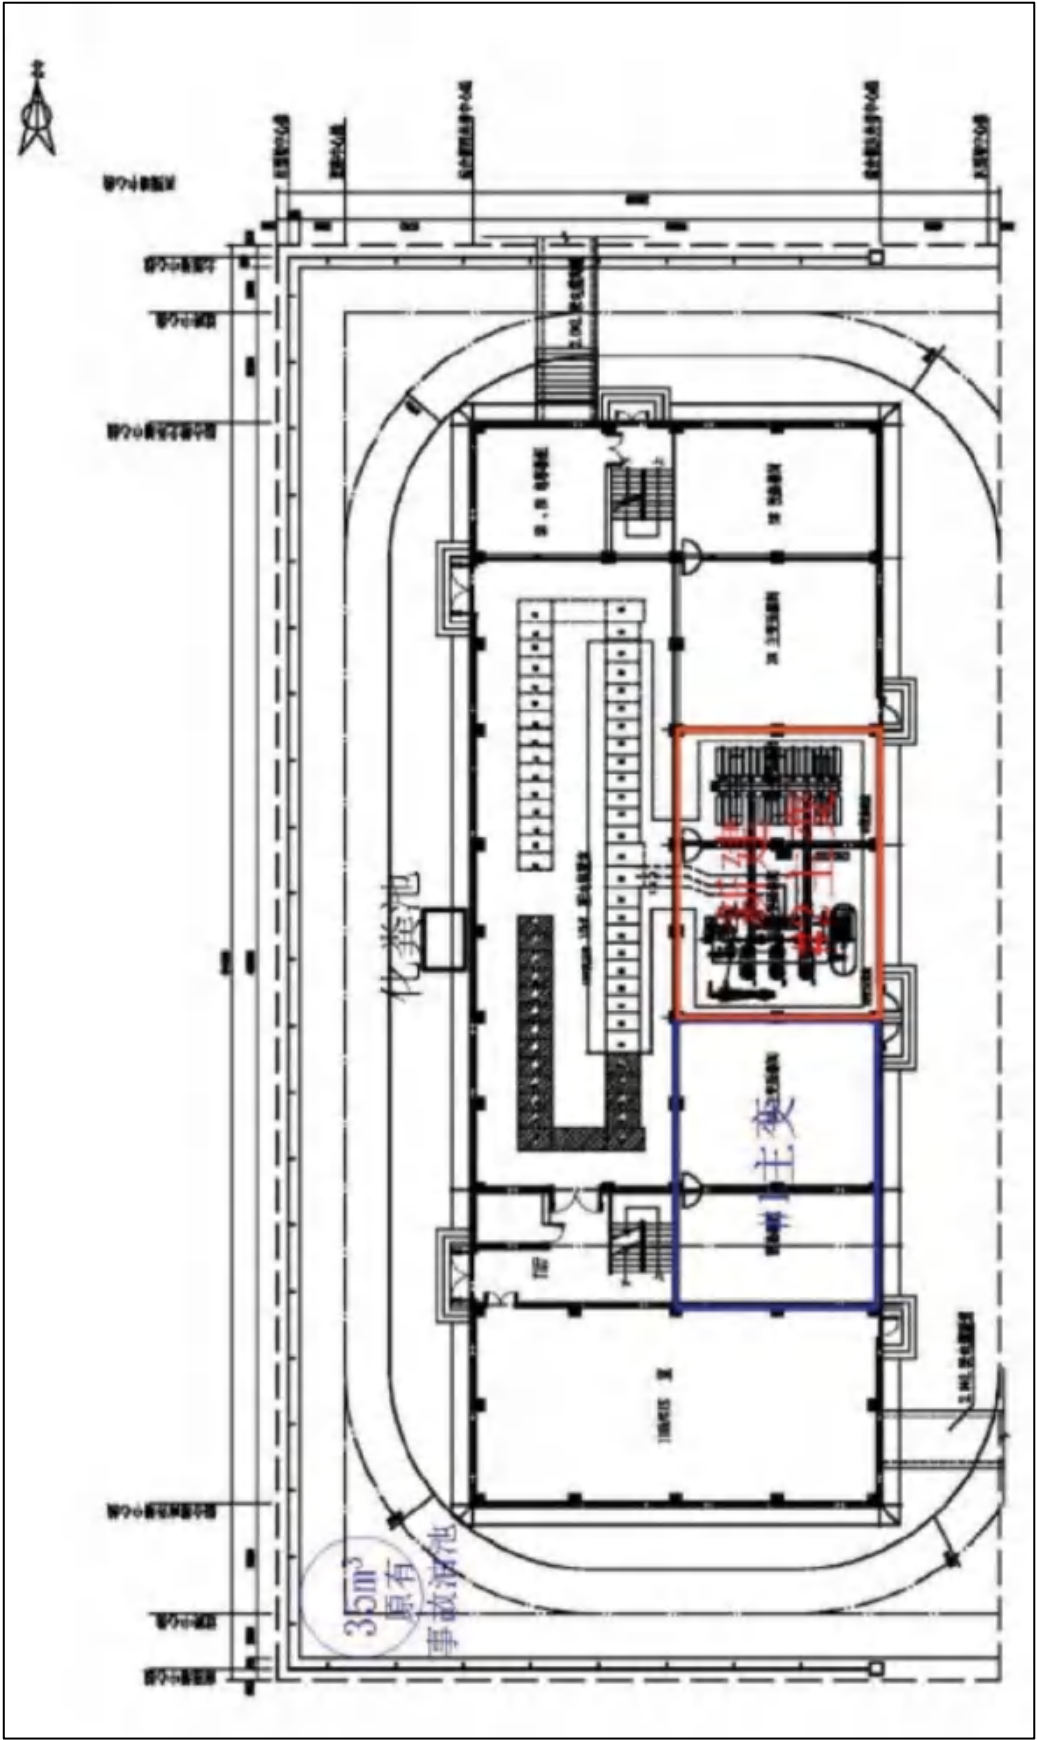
洛阳市区至真 110 千伏变电站平面布置示意图
